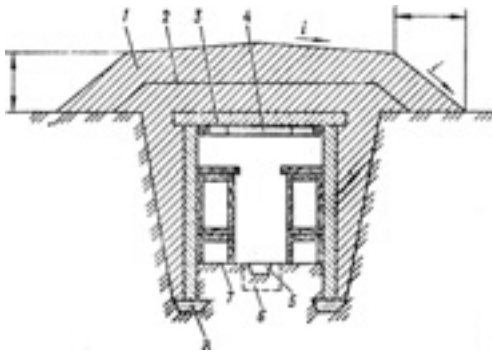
Однопролетное БВУ с распорной рамой из дерева: 1 – насыпной грунт; 2 – гидроизоляция; 3 – железобетонная плита; 4 – распорная рама; 5 – дренаж; 6 – приямок; 7 – земляной пол; 8 – щебеночная подготовка
